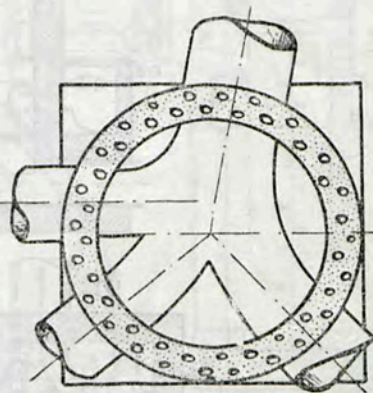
Studzienka żłazowa betonowa zestawiona z gotowych kręgów.
